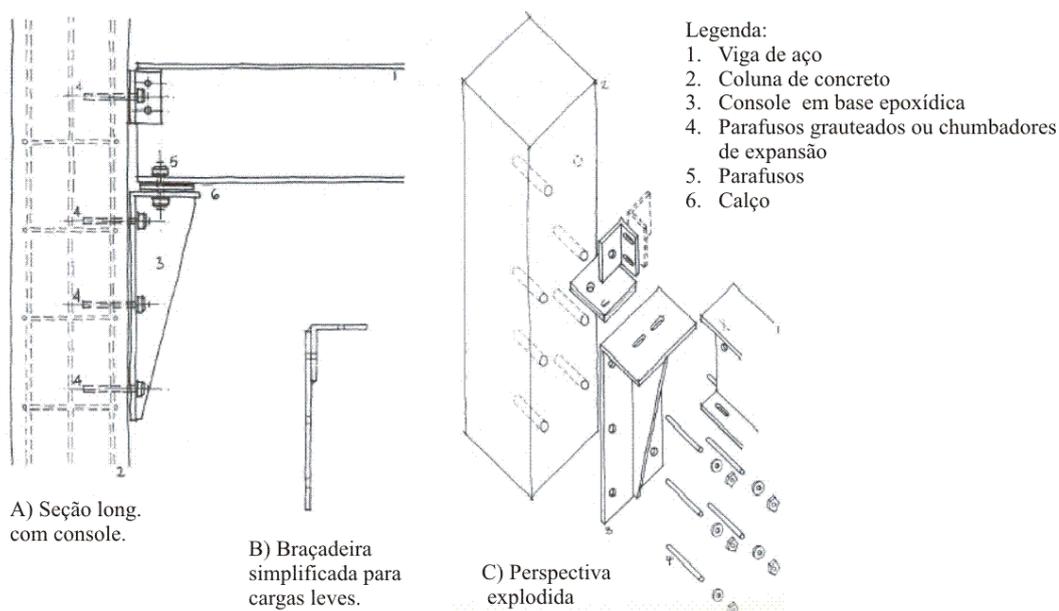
Interface entre viga de aço e pilar de concreto com console metálico.
